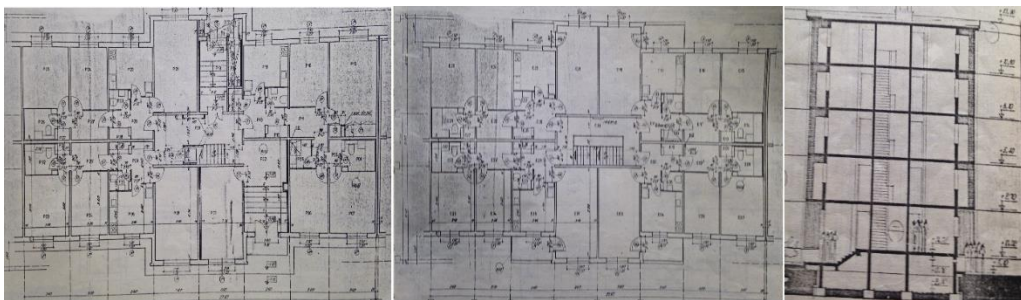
Proiectul tip T770IPCT Pb4. De la stânga la dreapta, plan parter, plan etaj și secțiune verticală.
